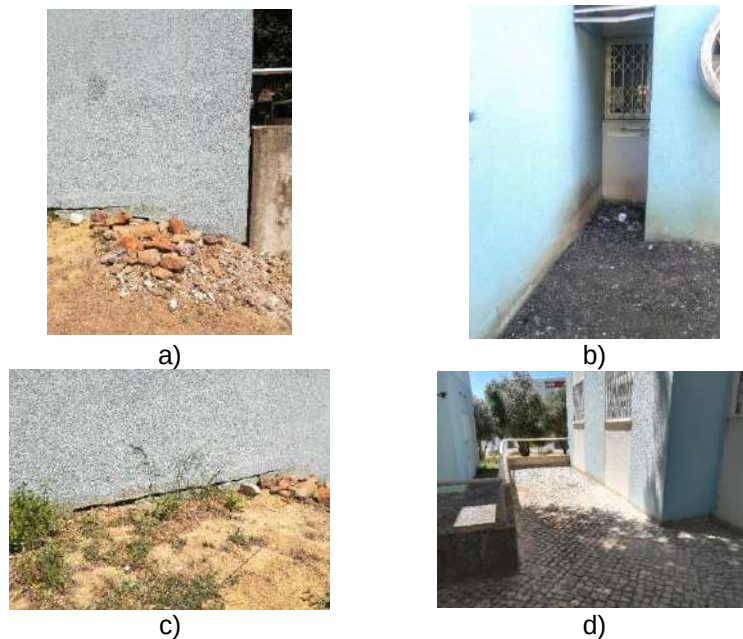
Patologias exteriores do edifício em estudo: a) destacamento do muro; b) assentamento do pavimento; c) fenda horizontal na fachada; d) assentamento dos pavimentos.
